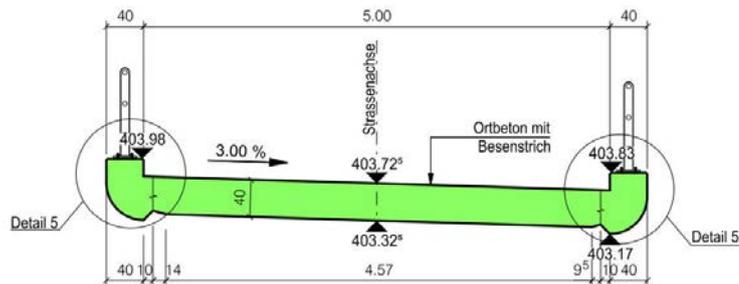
Querschnitt Brücke Iselstrasse, Hinterburgbach
